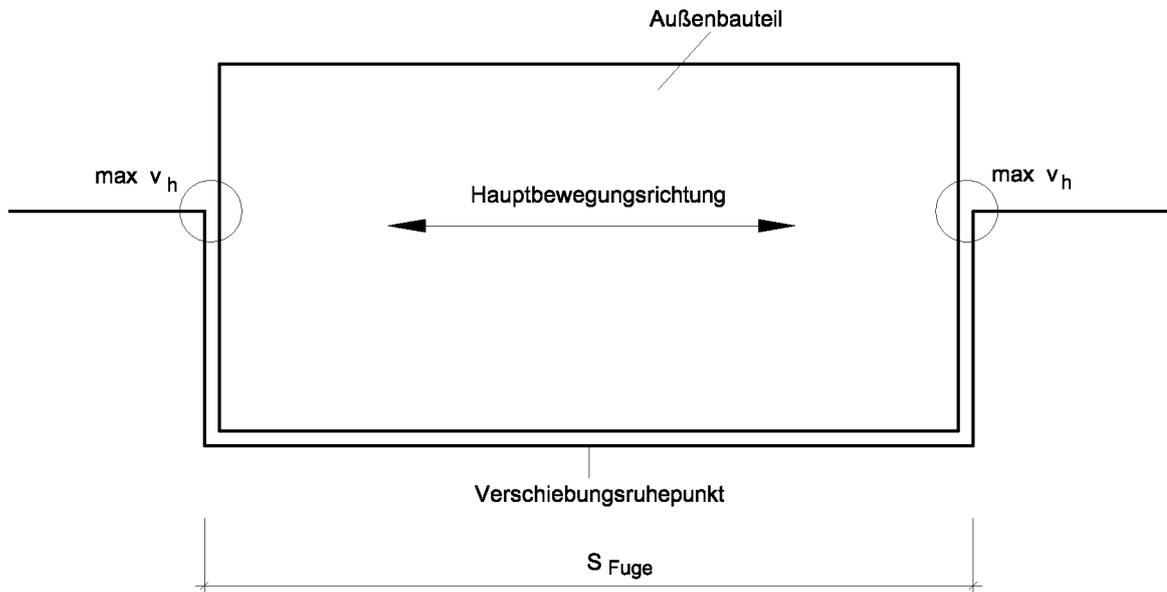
Einbausituation mit Lagerung an gegenüberliegenden Rändern
